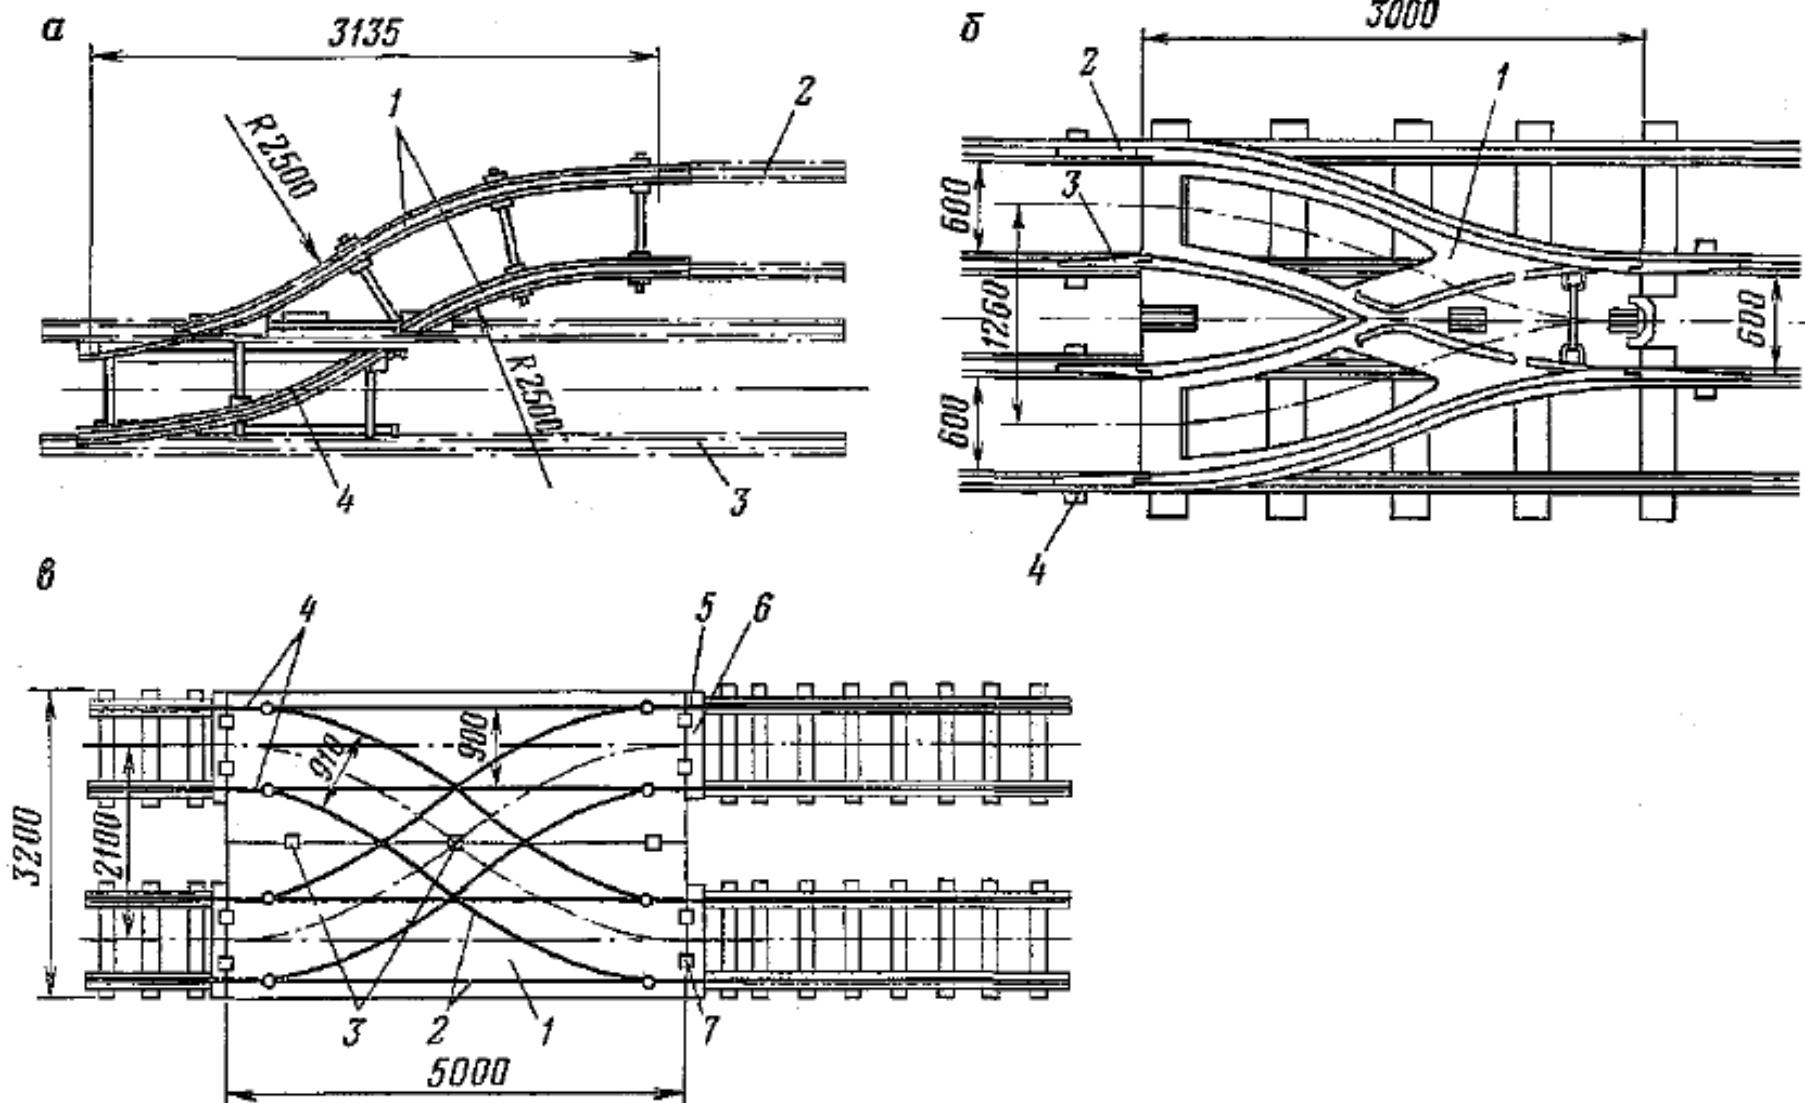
Обменные устройства для вагонеток: а – накладная стрелка; б – накладная плита-разминовка; в – накладная двухсторонняя плита-разминовка
